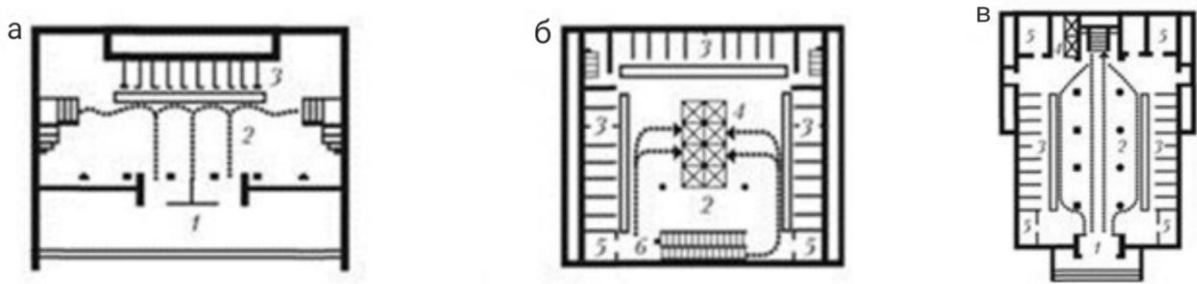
Планувальні схеми вестибюлів в громадських будівлях:
